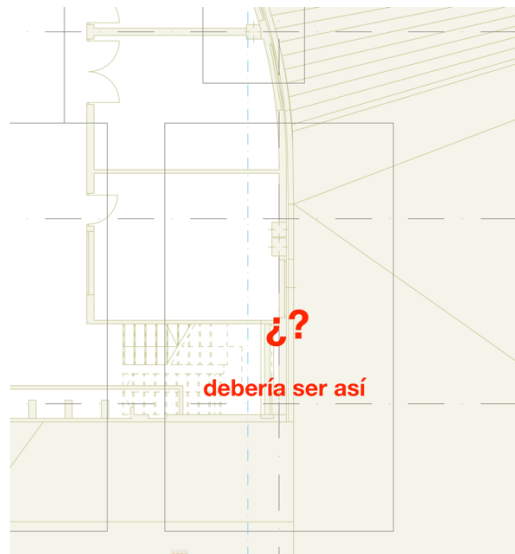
Falta de la zapata en donde apoya los pilares de la rampa.
